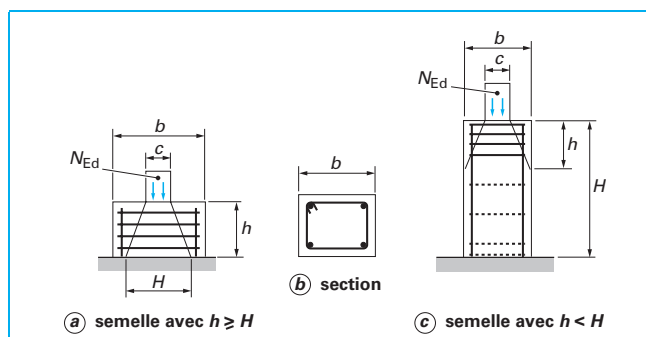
Armatures s'opposant à l'éclatement du béton dans une semelle fondée sur rocher (figure 9.14 de l'EC2)
